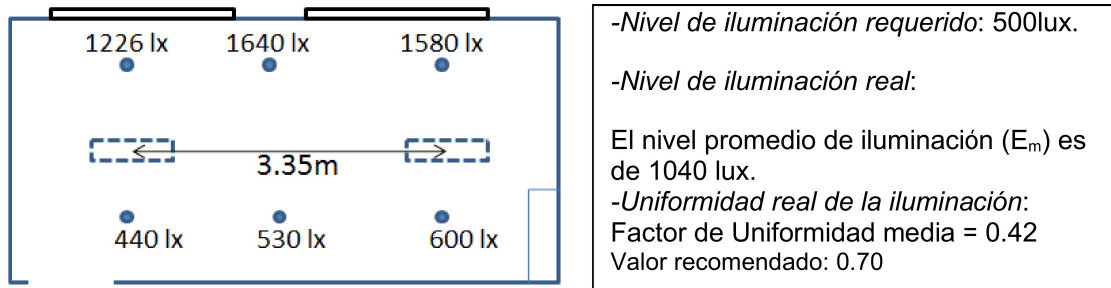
Planta esquemática aula 88, con medición de niveles de iluminación en lux
